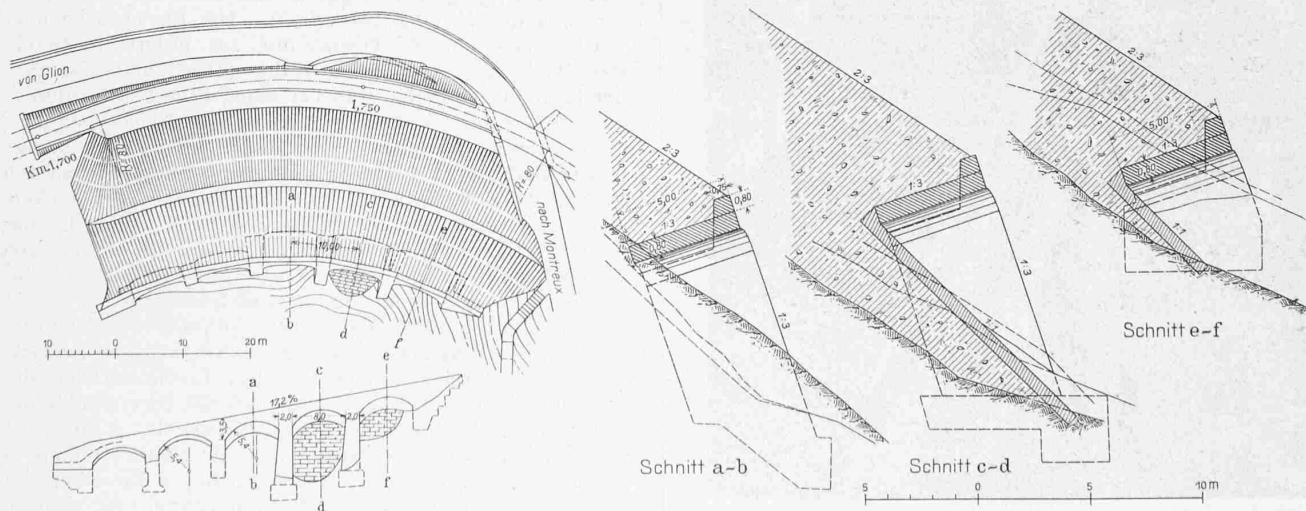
und 21. Lageplan und Ansicht (1:1000) und Schnitte (1:300) der Lehnengalerie in Abb. 22 für die Tunneldeponie.
